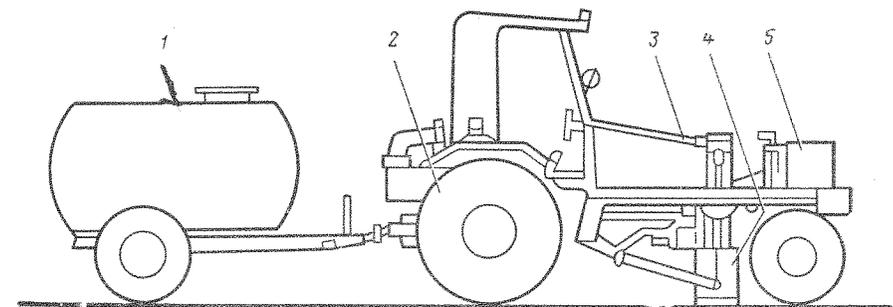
Общий вид аэродромного сверлильного станка ACC-0,15:
